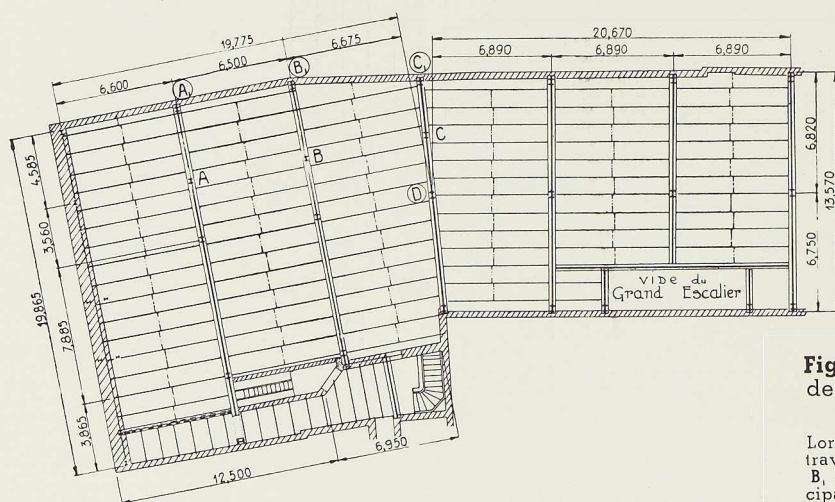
Plan de l'ossature du premier étage des nouveaux bâtiments.
